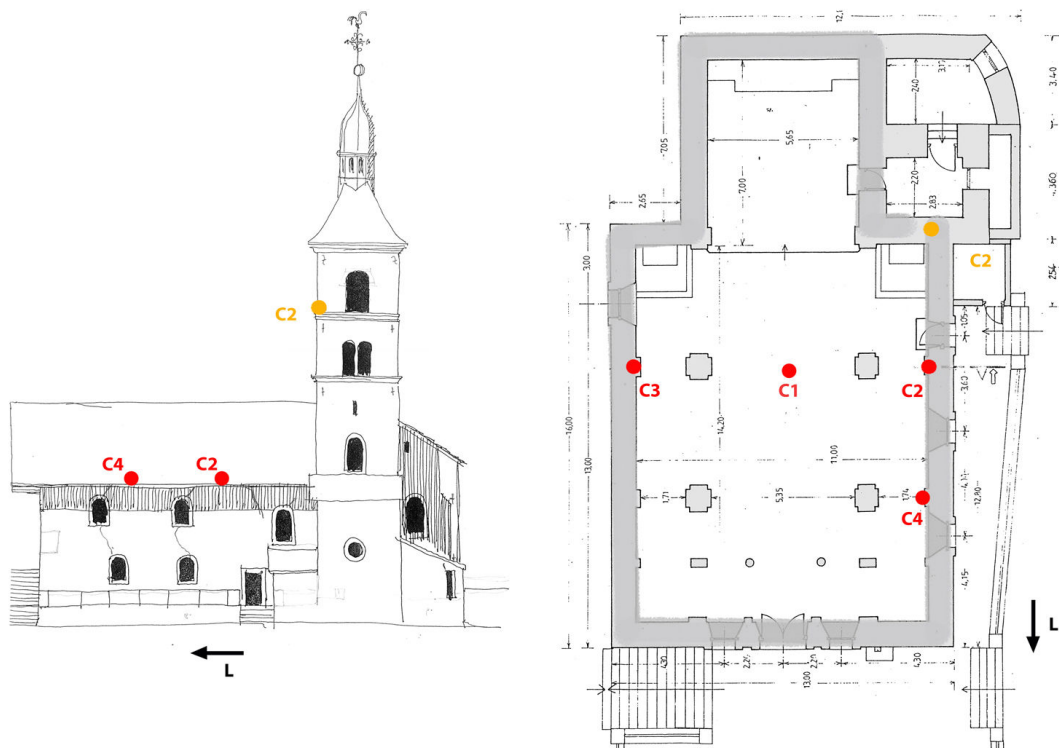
Exemple de position des capteurs pour les mesures partielles : église St Pierre, Villard-sur-Doron, Beaufortain. Plan et élévation longitudinale, échelle graphique.
